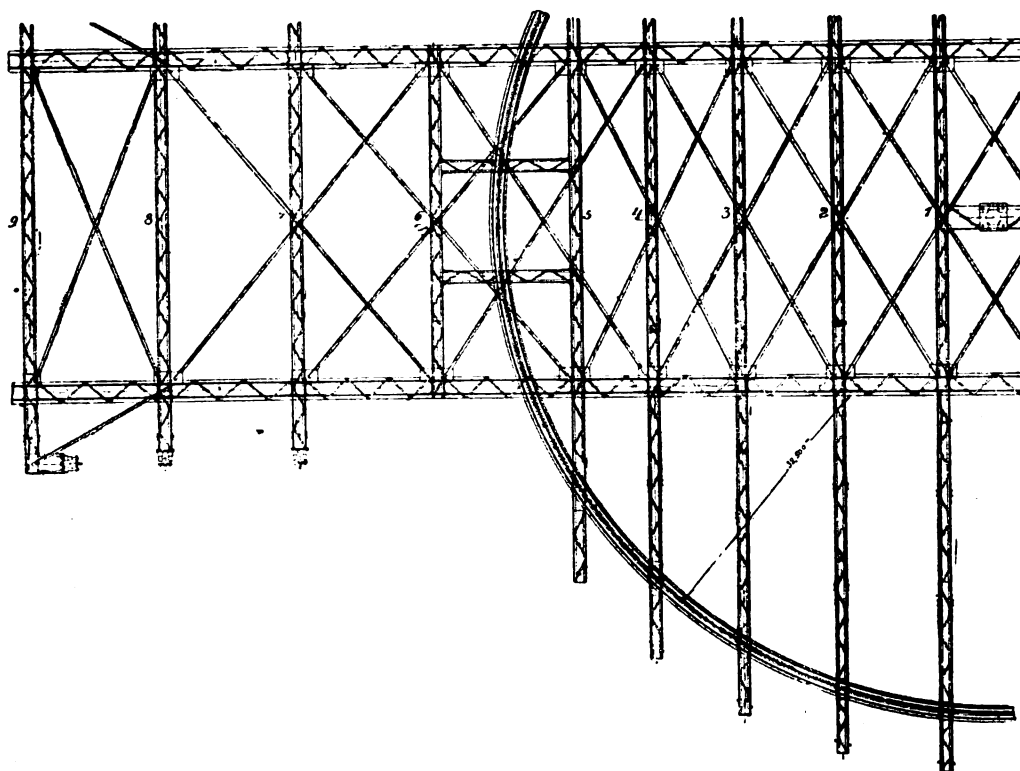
Pianta del supporto del serbatoio (Scala 1:250).
